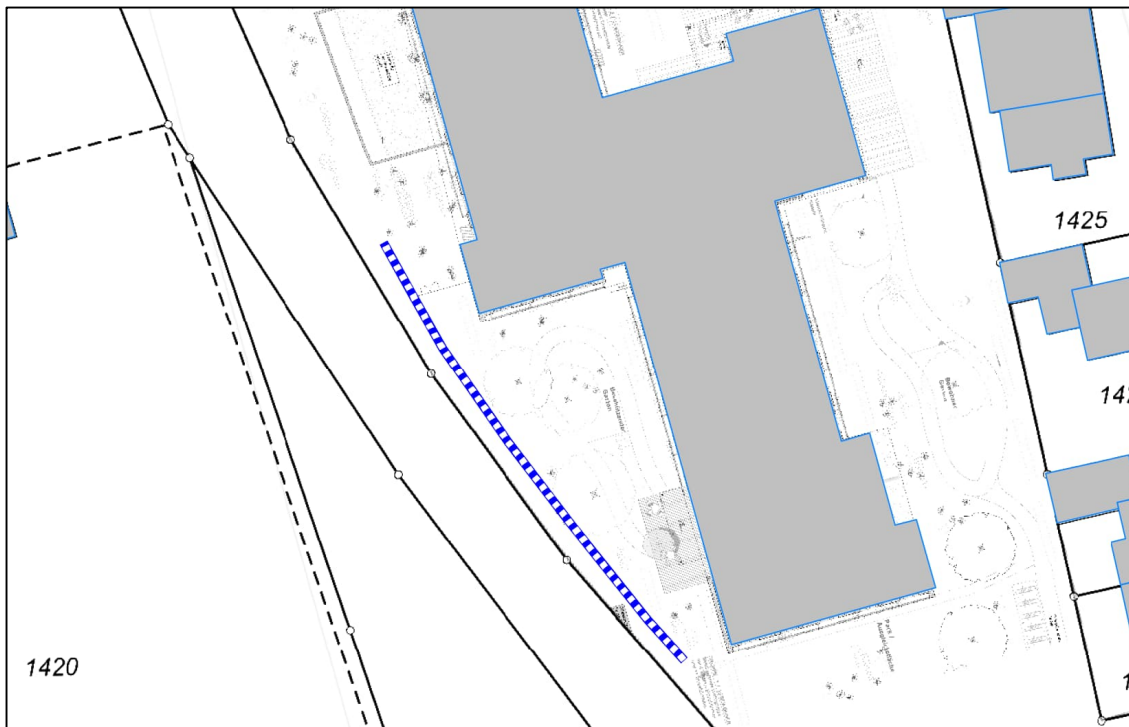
Lageplan mit Darstellung der Lärmschutzwand des beschützenden Gartens
